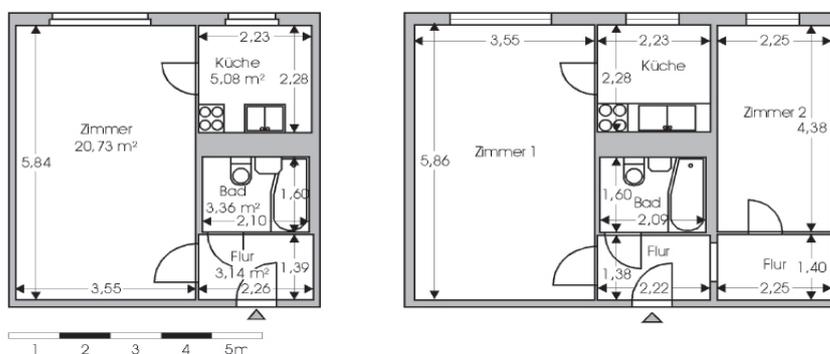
WBS 70-Grundriss-1-2-Raumwohnungen
